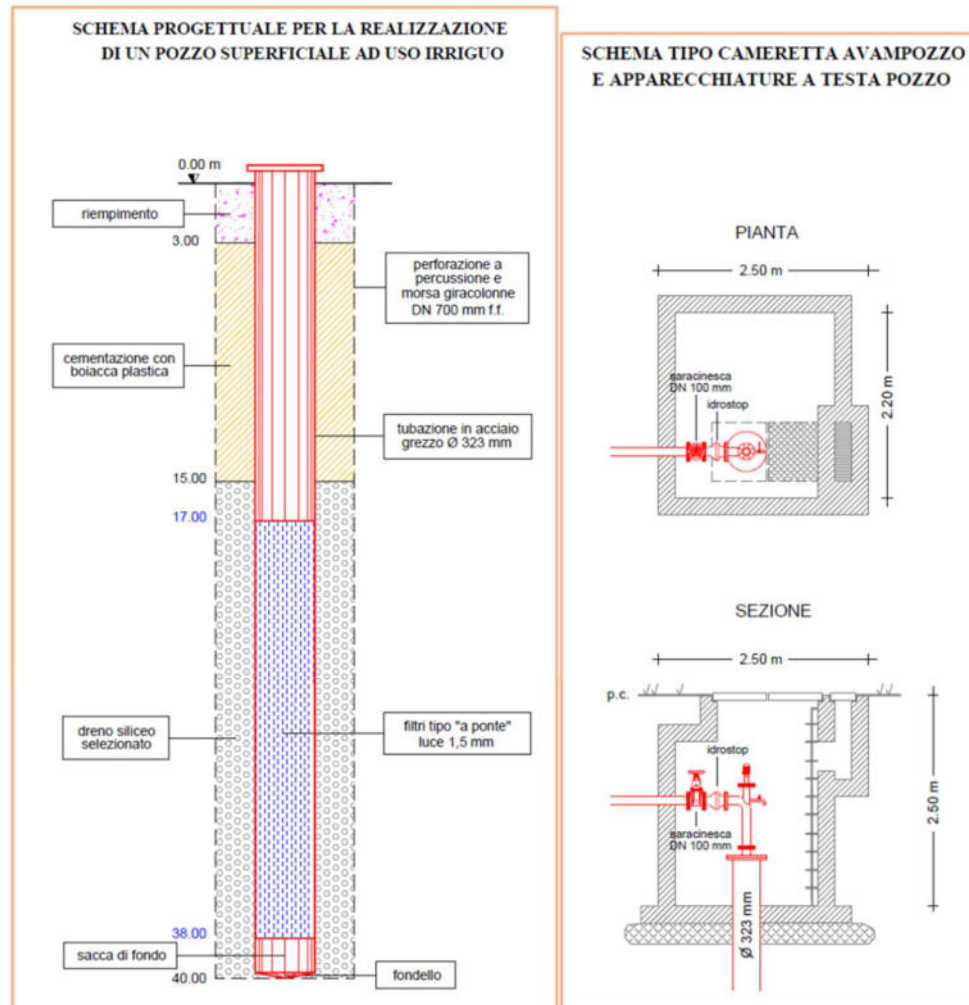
schema progettuale, cameretta avampozso e apparecchiature del pozzo in progetto (fonte elaborato 5.7 del PA)
